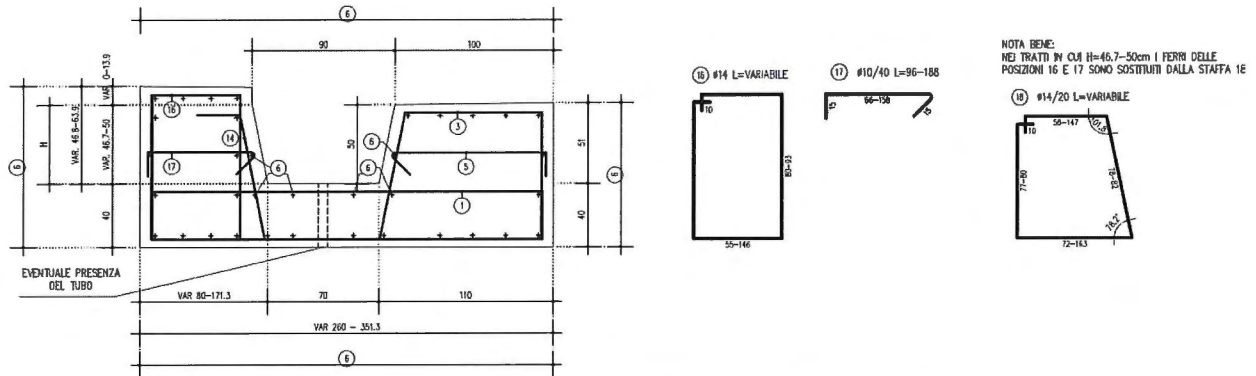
Schema armatura - Sezione Tipo D (Barriera Doppia) – Tratto 4
